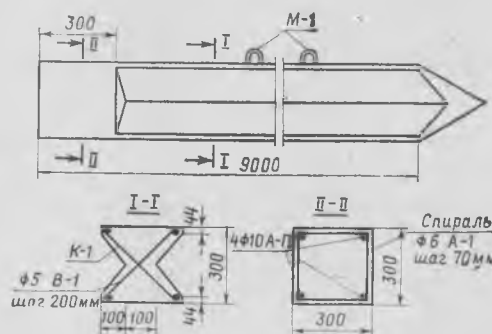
Конструкция железобетонной сваи Х-образного сечения
